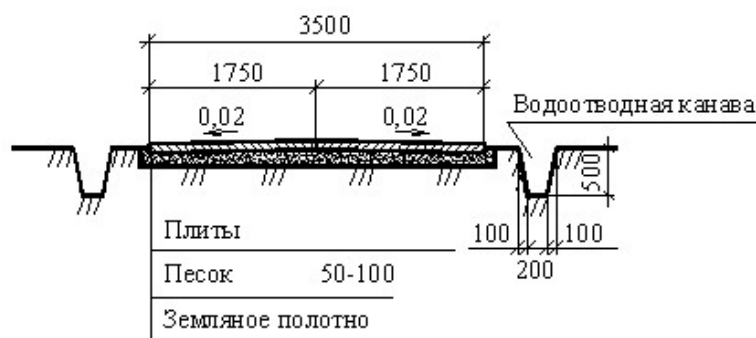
Тип 2. Двускатная дорога из сборных железобетонных плит шириной 3,5 м
